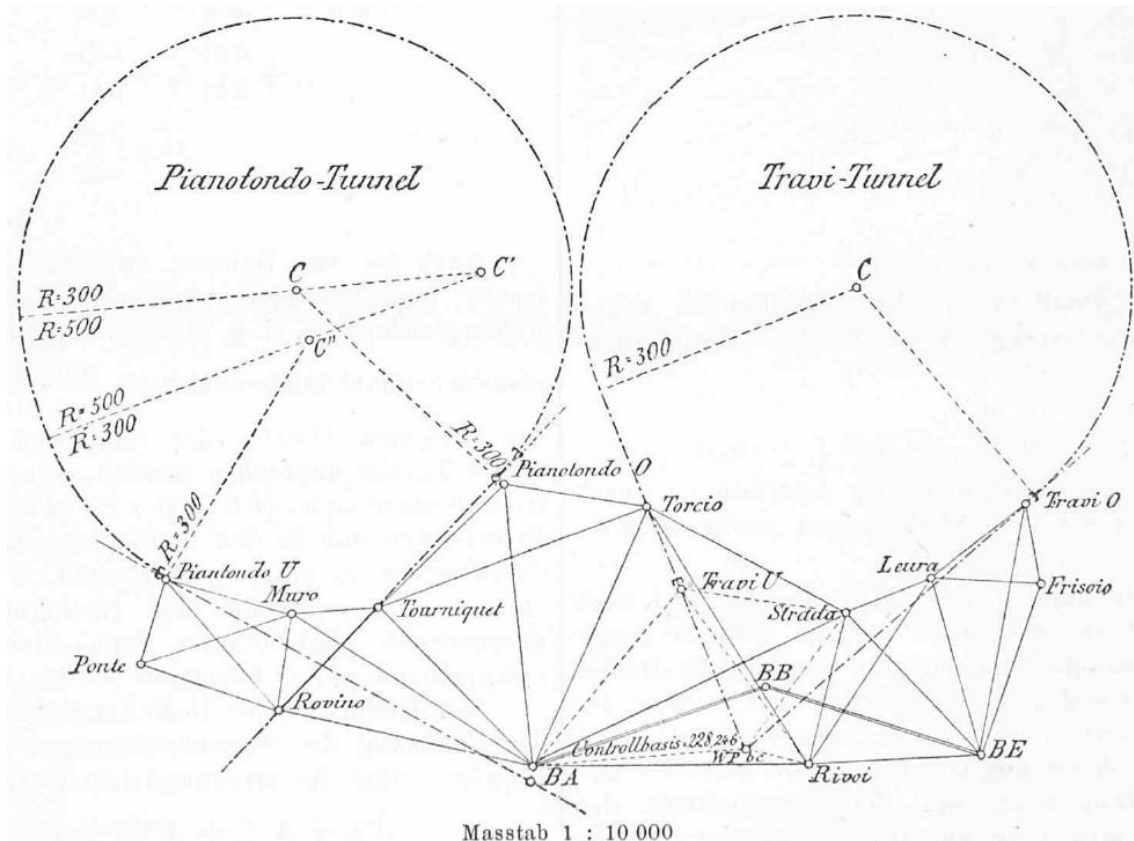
Pianotondo und Travi, Tunnelachse und Geometrie (Koppe 1880b, S. 41)
